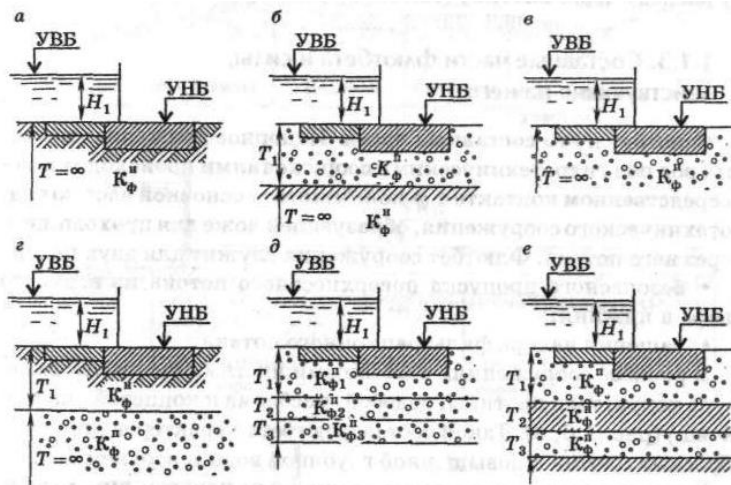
Примеры расчетных схем напластований грунтов в основании сооружений:
